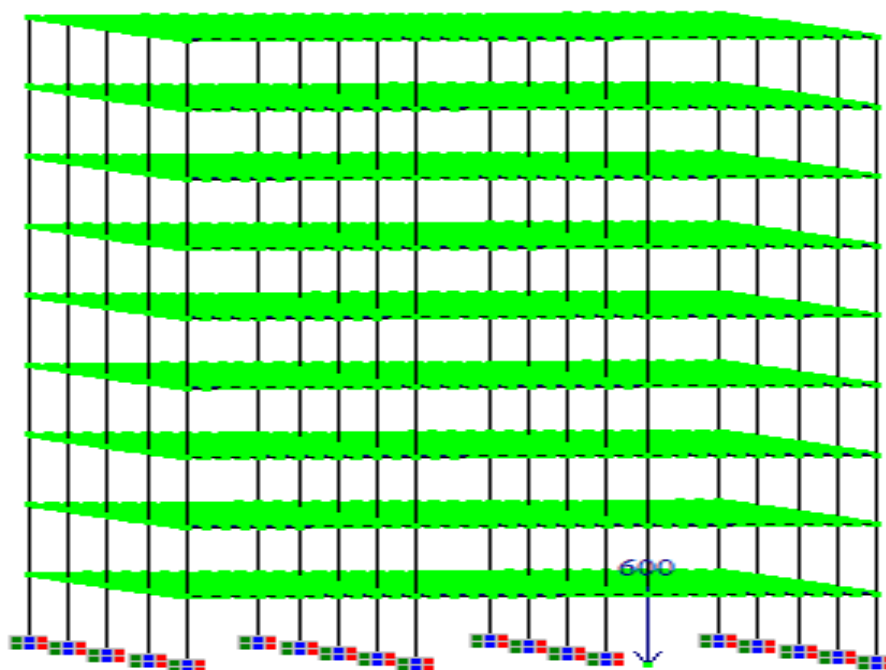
Schéma illustratif du modèle d'étude du bâtiment avec planchers en hourdis à 9 niveaux avec un chargement vertical sur le poteau de rive
